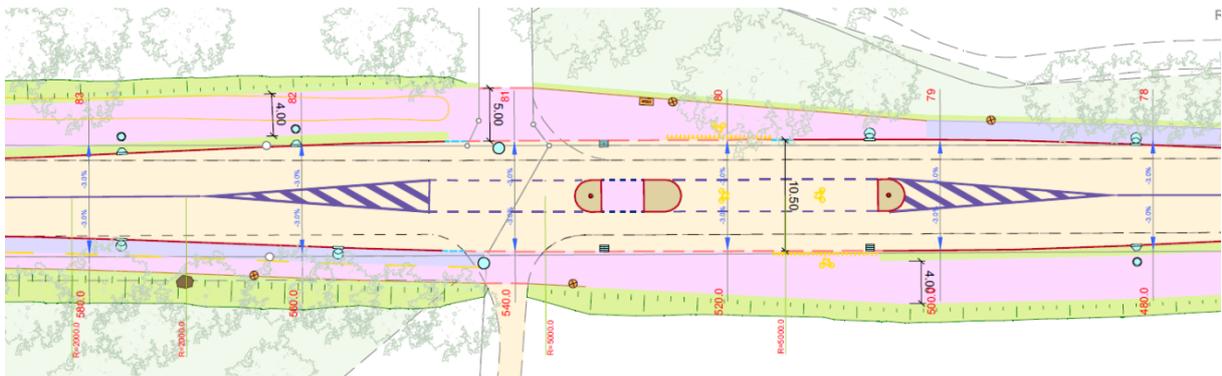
Aménagement de la traversée de la voie verte sur le secteur hors localité de Lully
